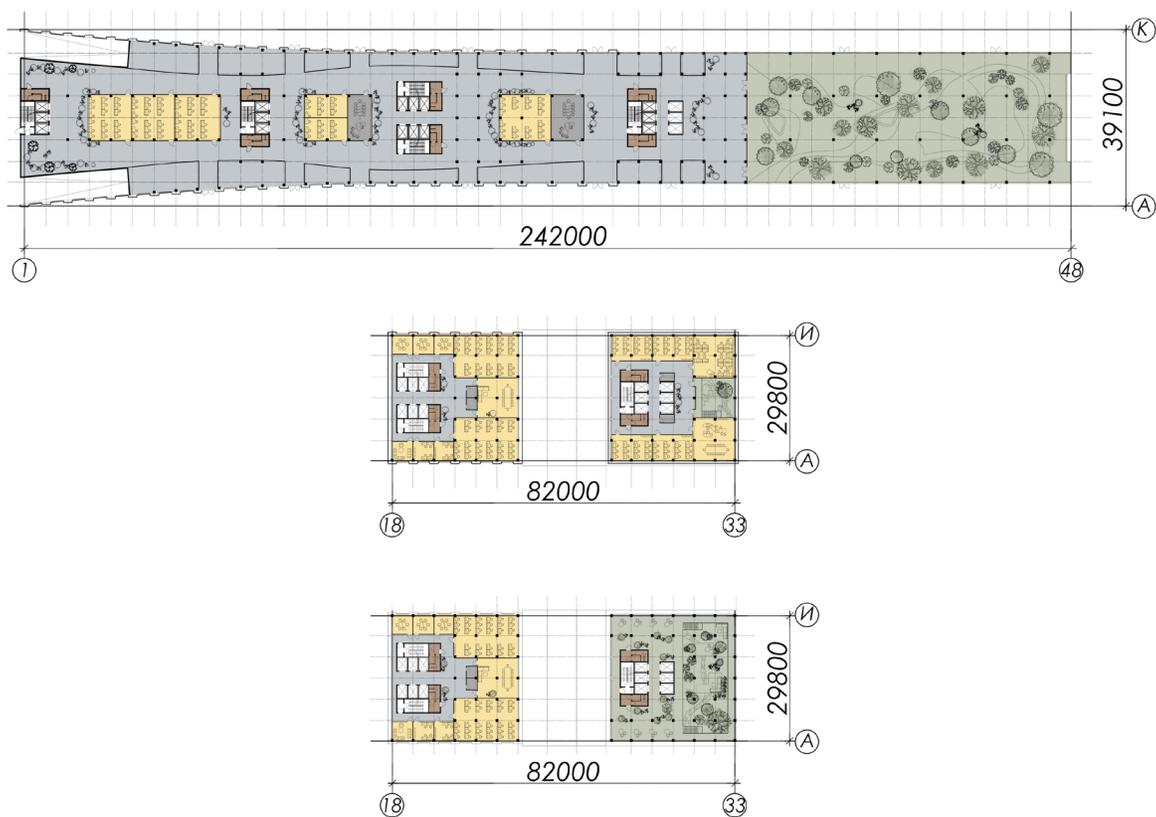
Схема планировки общественного здания: а – схема плана 1-го этажа; б – схема плана типового этажа; в – схема плана на уровне «небесного сада»
